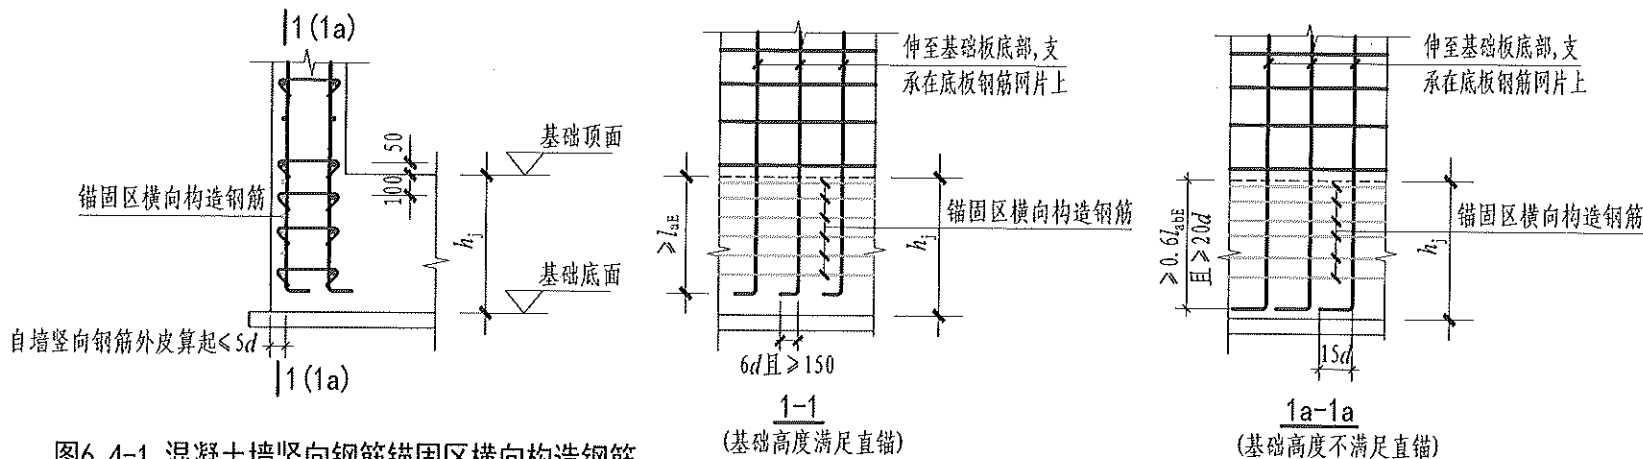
混凝土墙竖向钢筋锚固区横向构造钢筋
